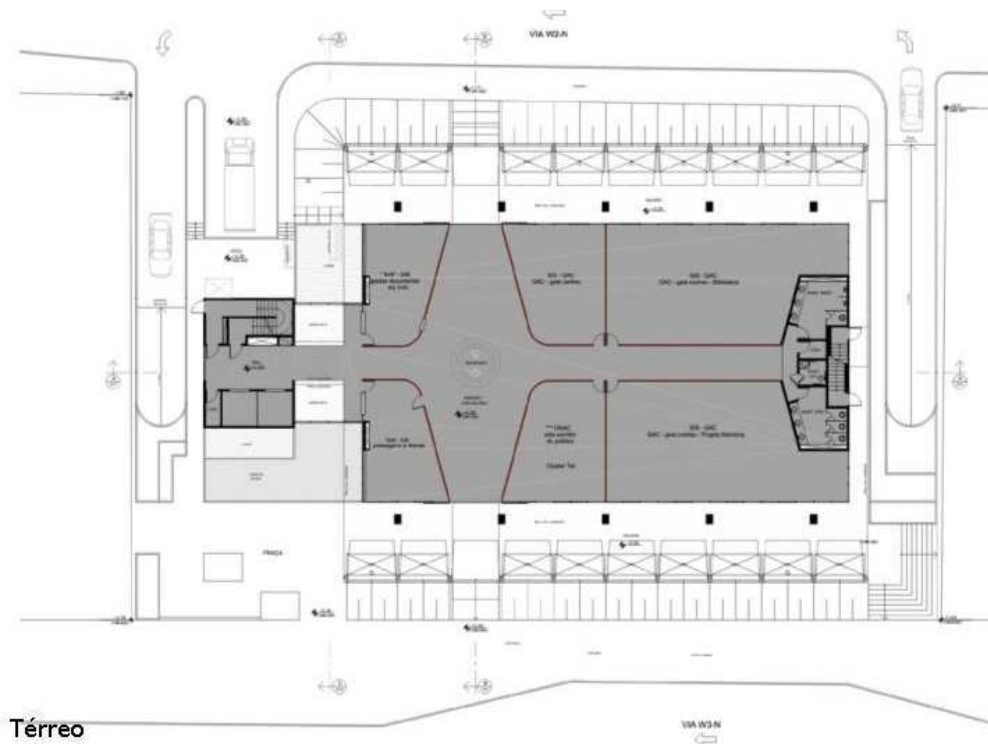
Planta Baixa | Pavimento Térreo. (FONTE: SKYSCRAPERS, 2011).
